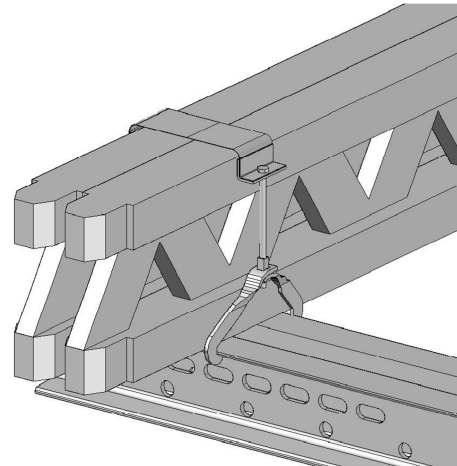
particolare aggancio trave con staffa universale HBUD - 104096
